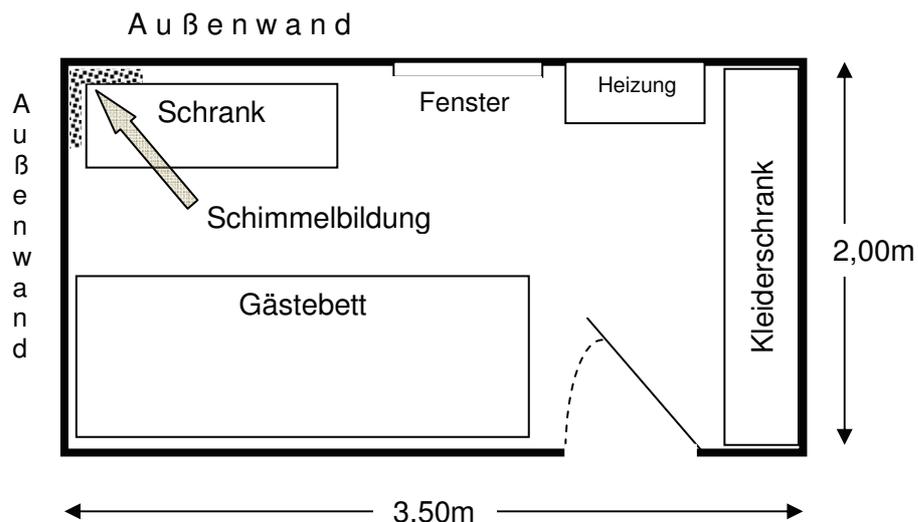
Grundriss und Möblierung des untersuchten Raumes
